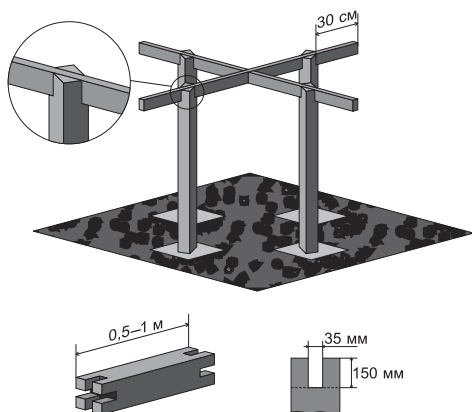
Установка крестовины на опоры (а) и подготовка стойки для перекрытия (б)
